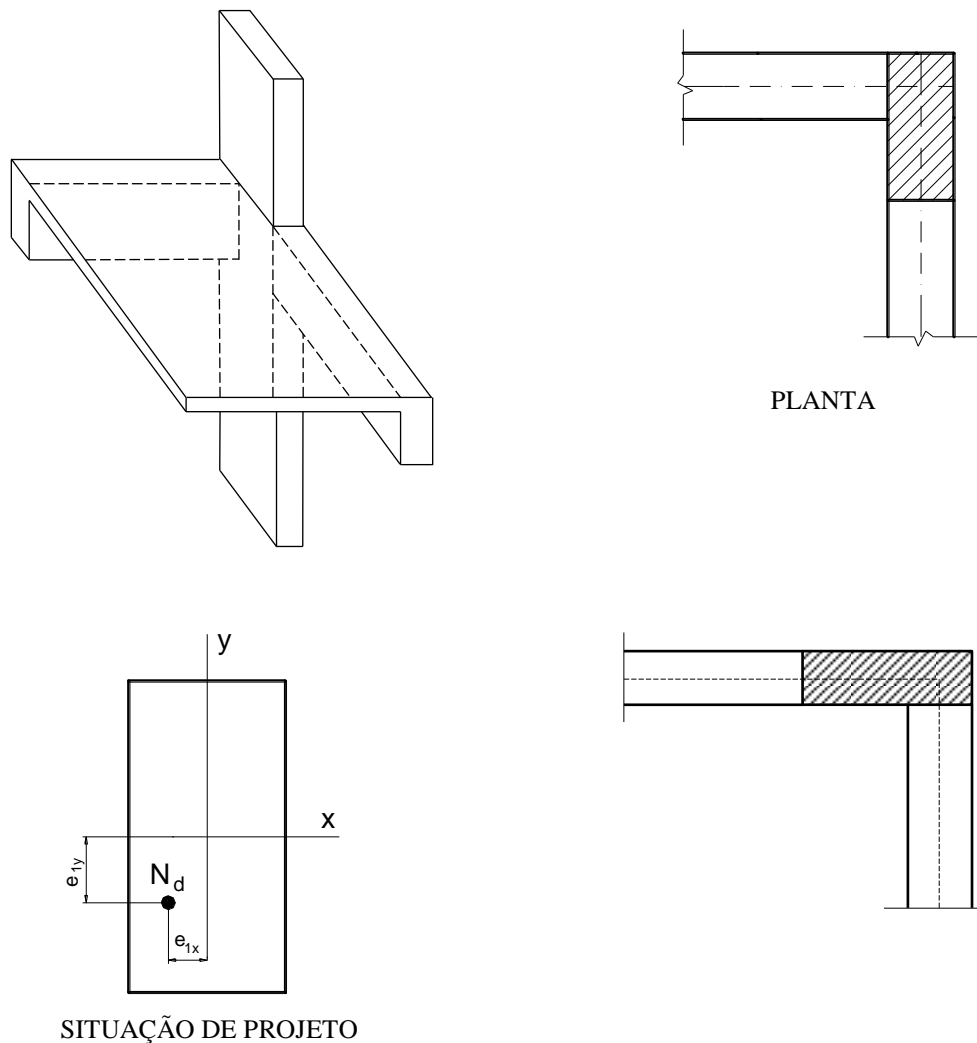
Arranjo do pilar de canto na estrutura real, em planta e situação de projeto.
